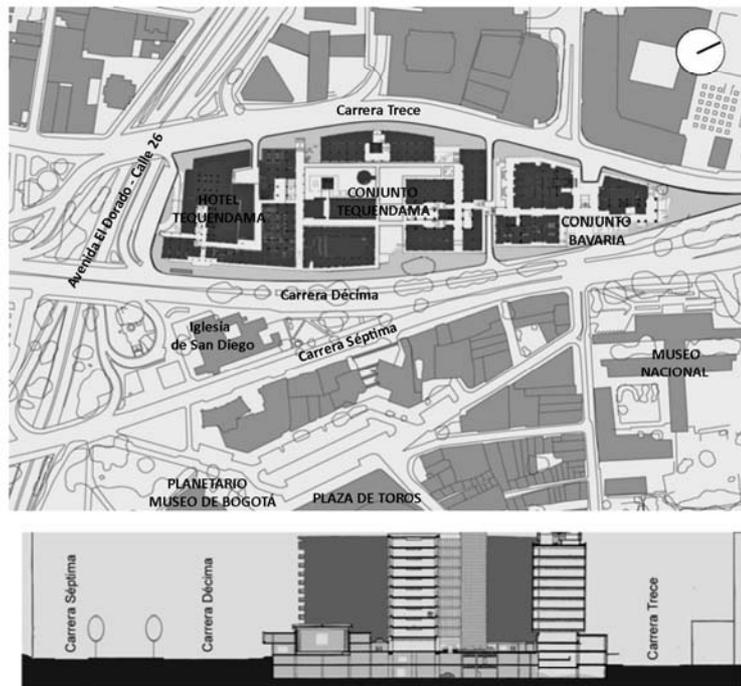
Planta baja y sección urbana. Fuente: Fontana, 2010
